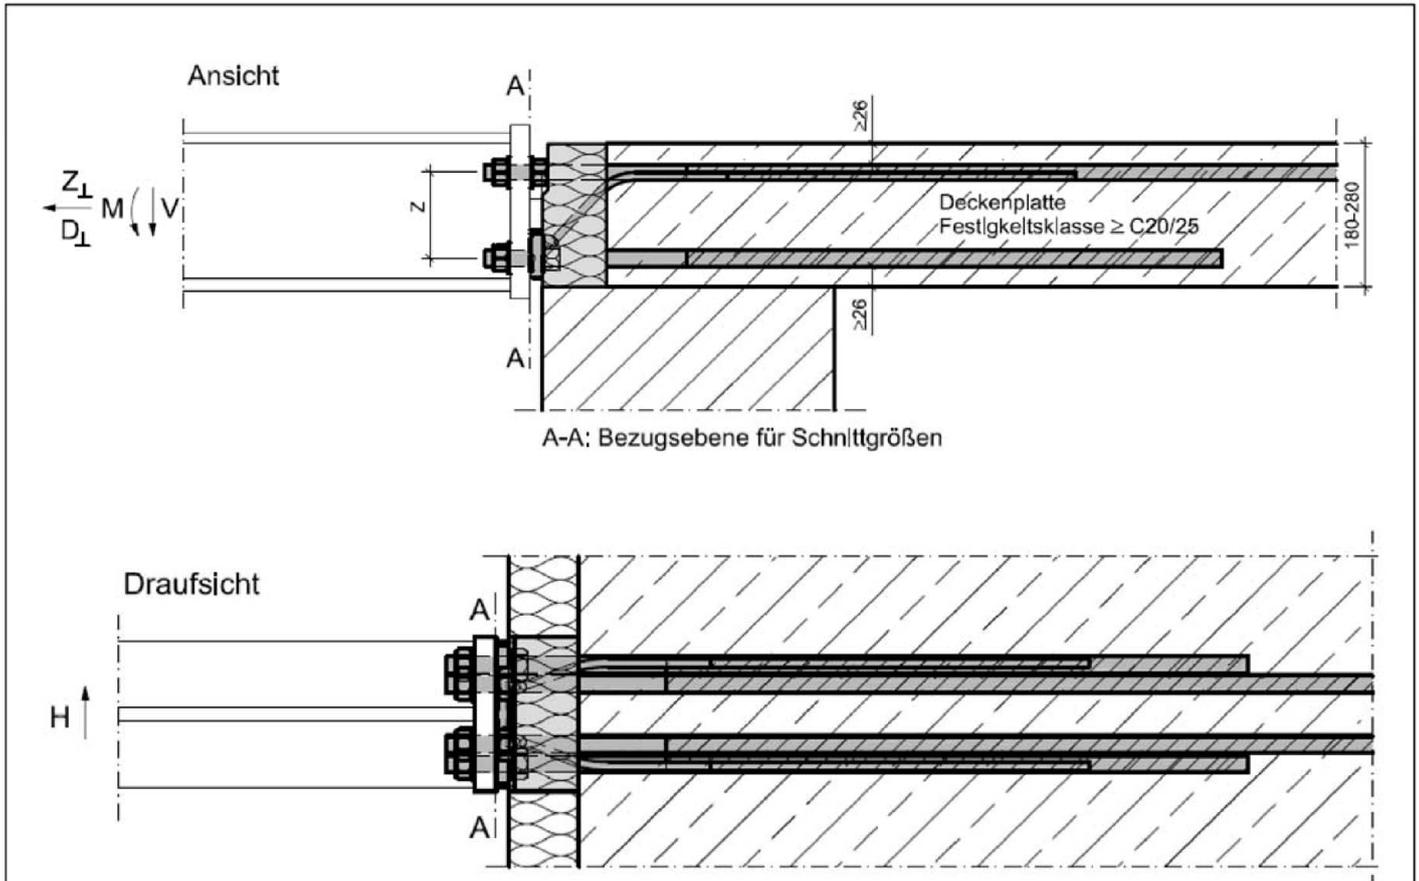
und 58: Schöck Isokorb® T Typ SK-MM2-VV1, Schnittgrößendefinition
